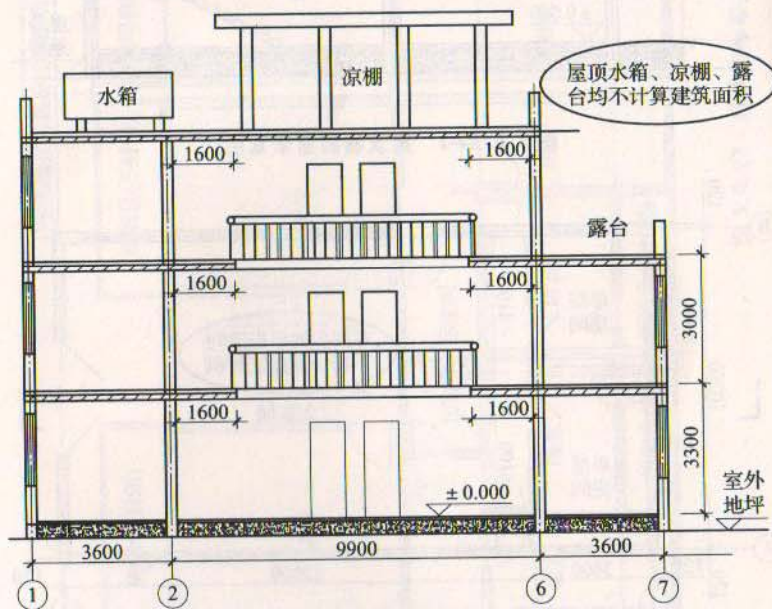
建筑物屋顶水箱、凉棚、露台平面图
